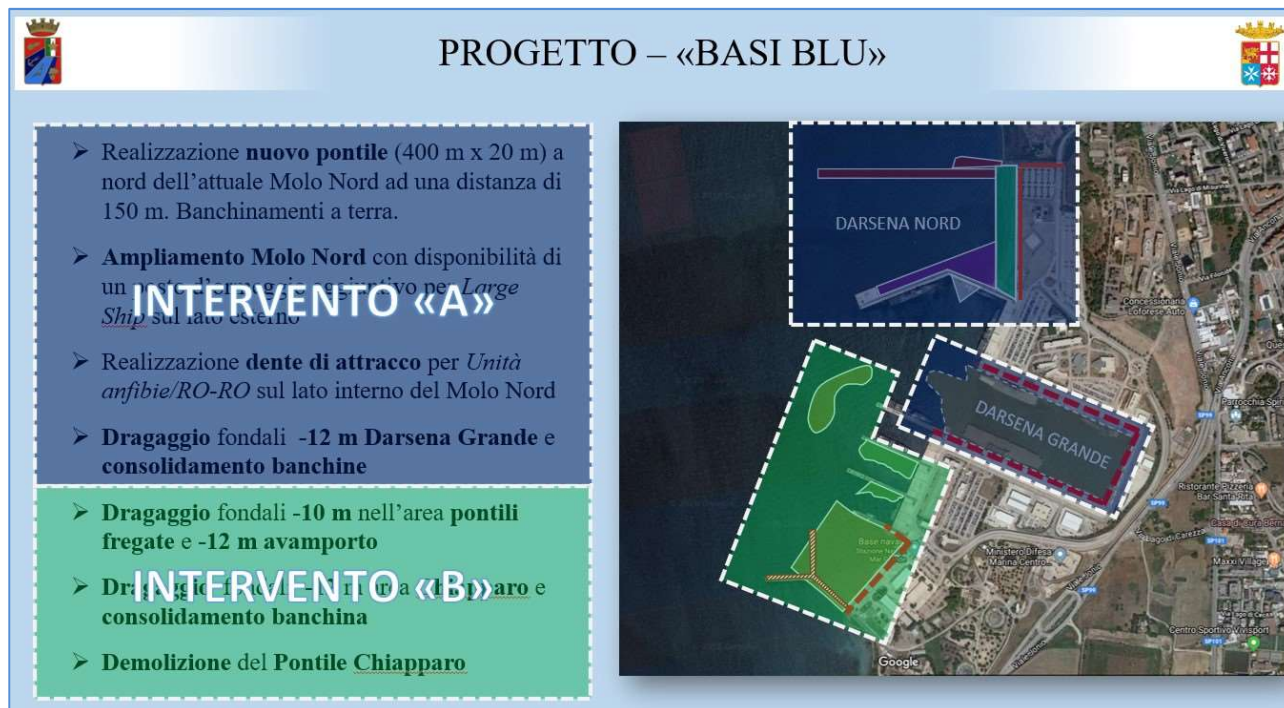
Raffigurazione planimetrica Intervento A e Intervento B
